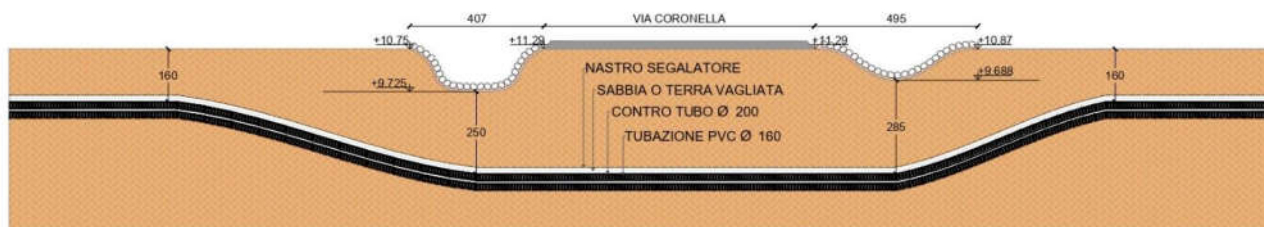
Tratto B-B' - Sezione attraversamento Via Coronella con la TOC
